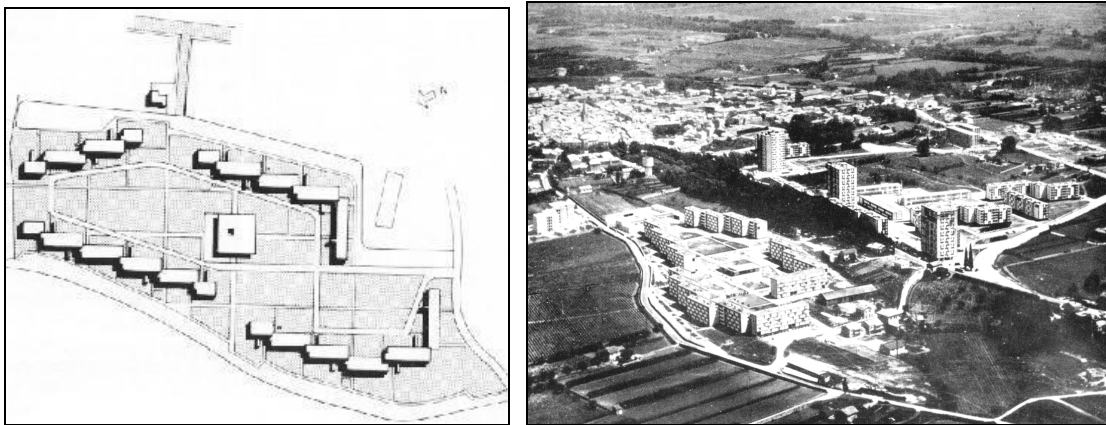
e 75: Planta e vista aérea do Conjunto Bagnols-sur-Cèze de 1955-61.
